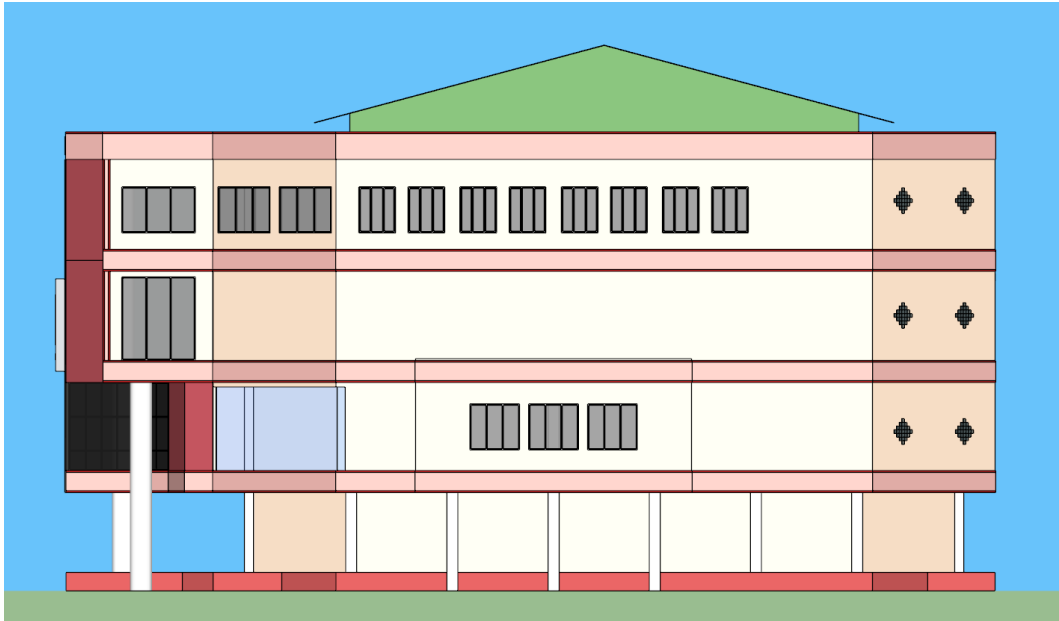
15 Fasad Tampak Barat Eksisting
